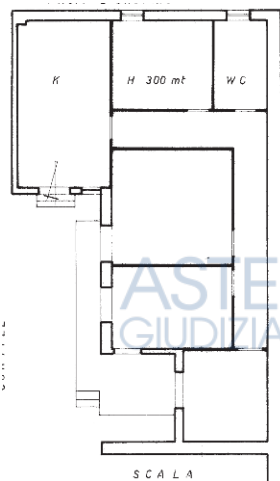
planimetria catastale dell'appartamento al piano rialzato
